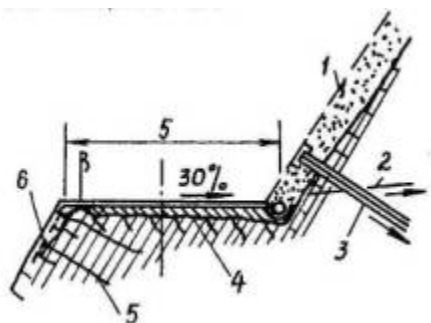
Укрепление скального откоса бермы, используемой для строительства местной дороги:
